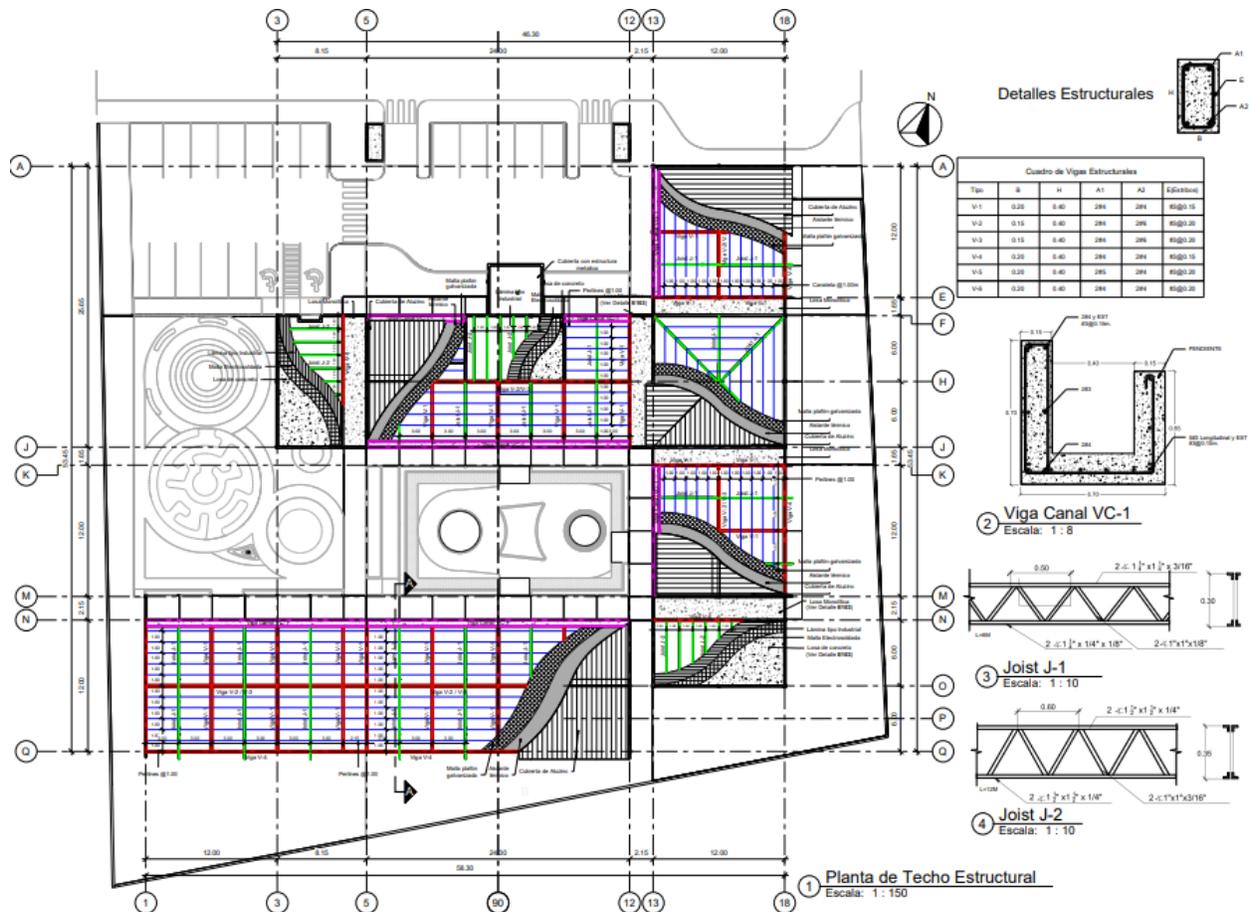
Planta de techo estructural. Fuente: Elaboración propia
